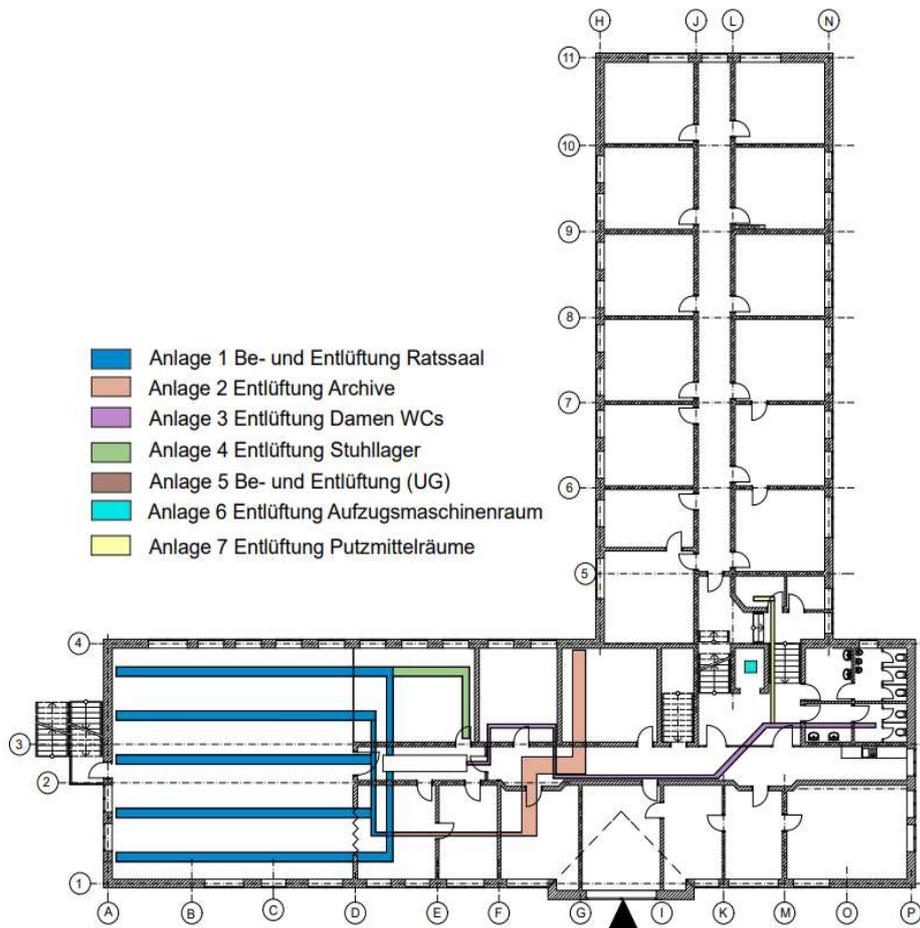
Lüftungsanlagen 3.und 4.Obergeschoss
